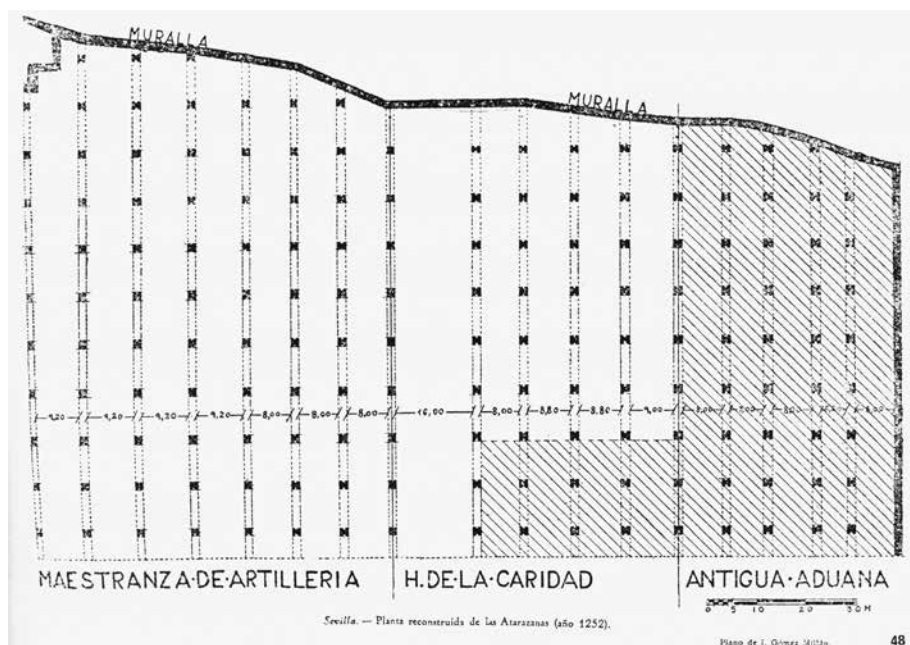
Reconstrucción de la planta de las Atarazanas de Sevilla (J. Gómez Millán).
